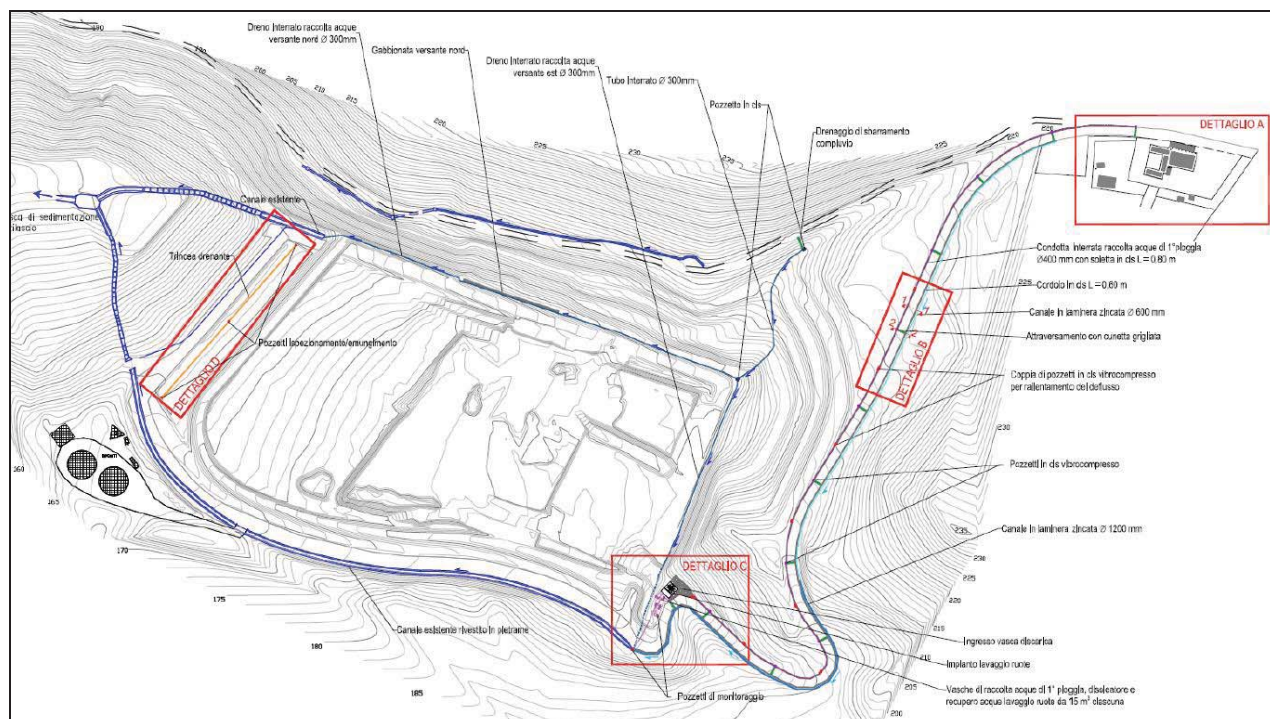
Planimetria del sistema di raccolta e trattamento acque di prima pioggia
